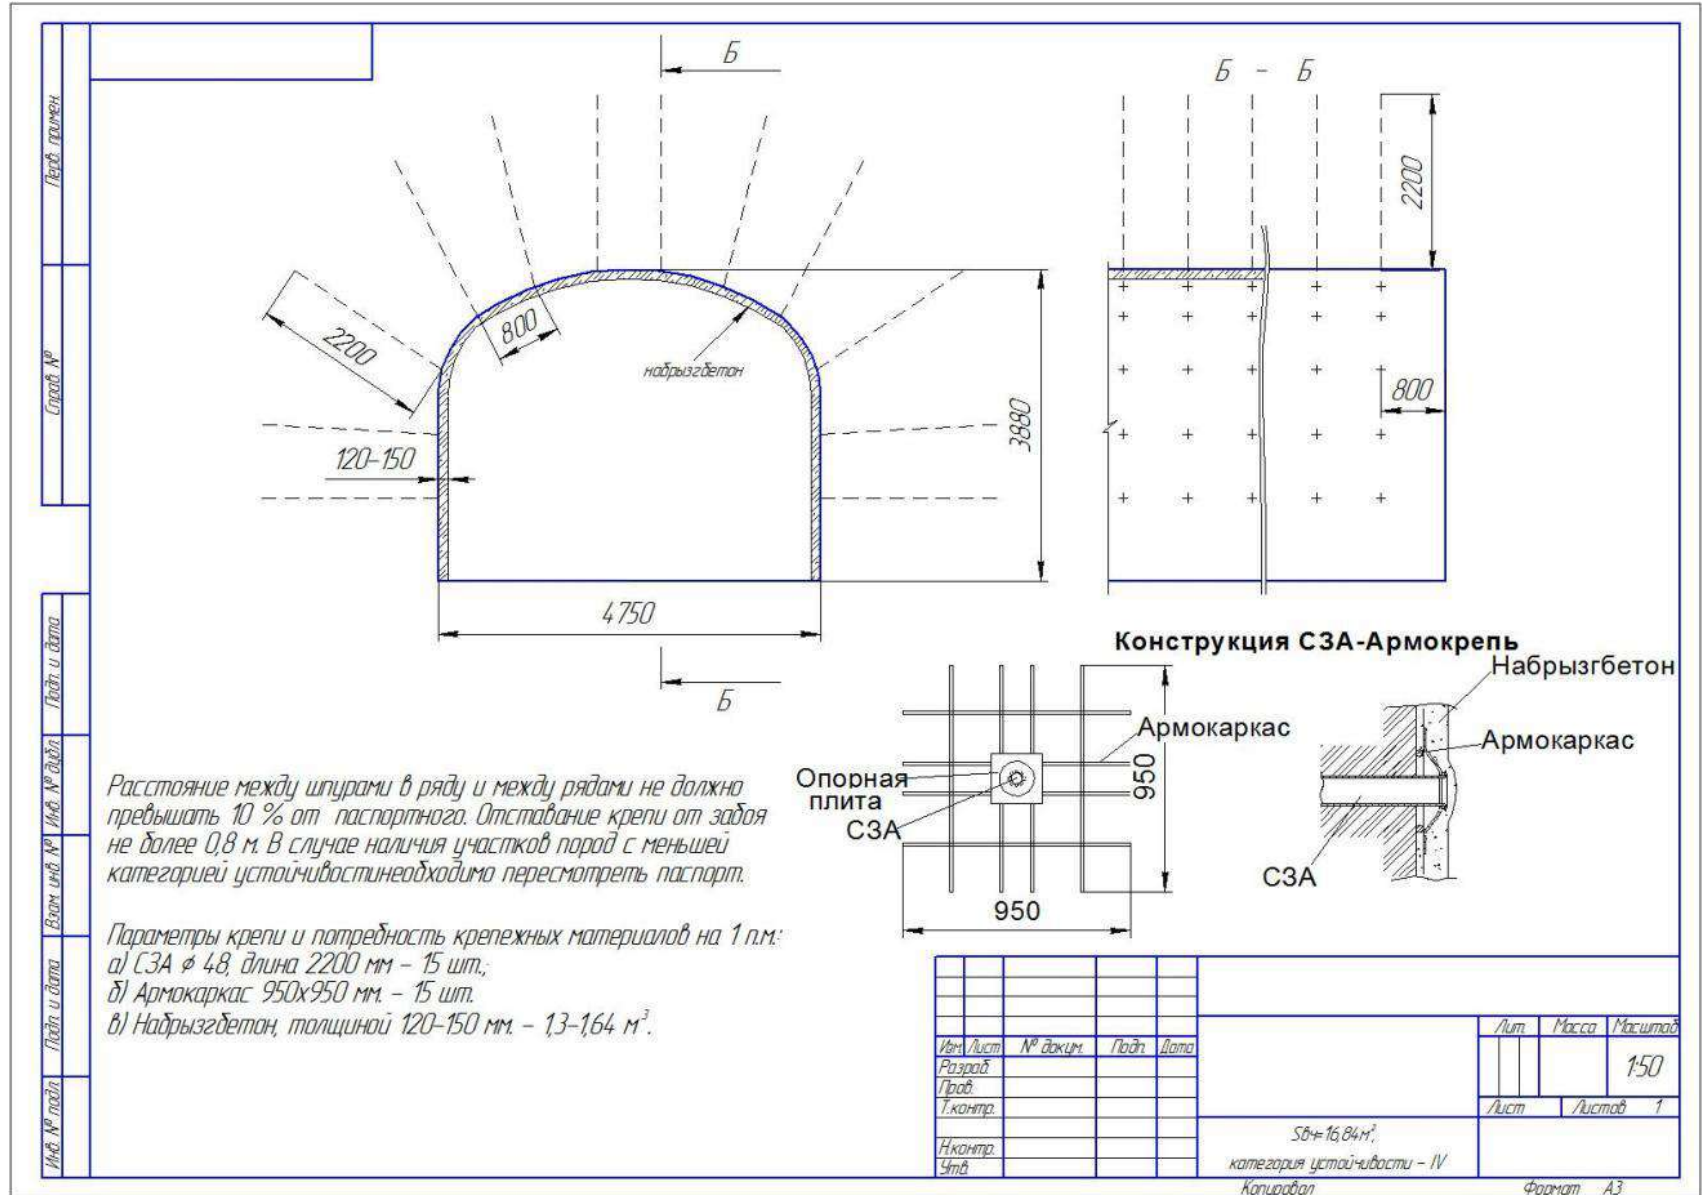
Паспорт крепления горной выработки, шириной 4,75м СЗА – Армокаркас с набрызгбетоном
